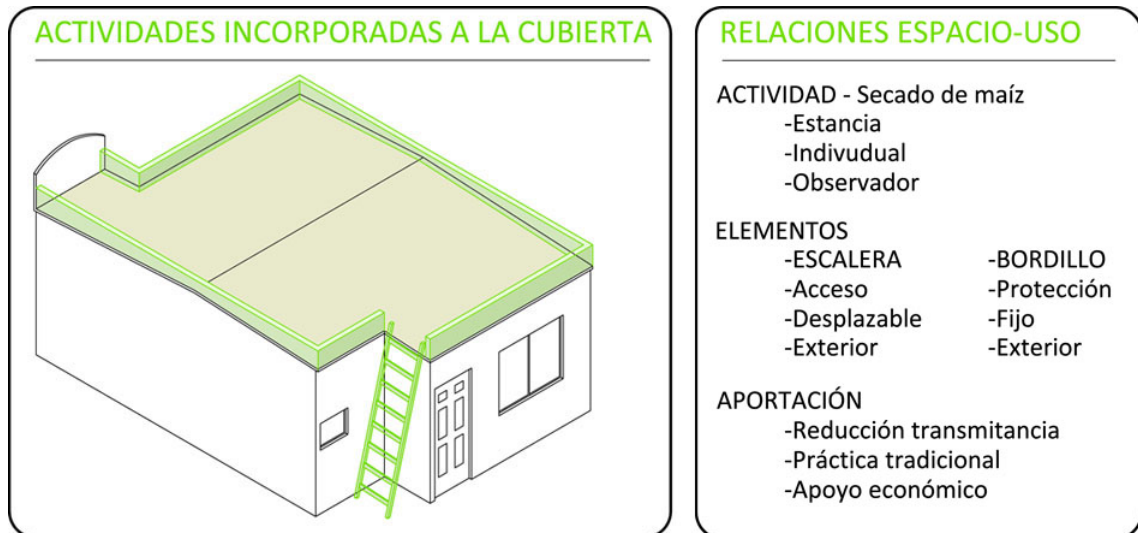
Elementos arquitectónicos que facilitan la condición de habitabilidad de la cubierta plana.
